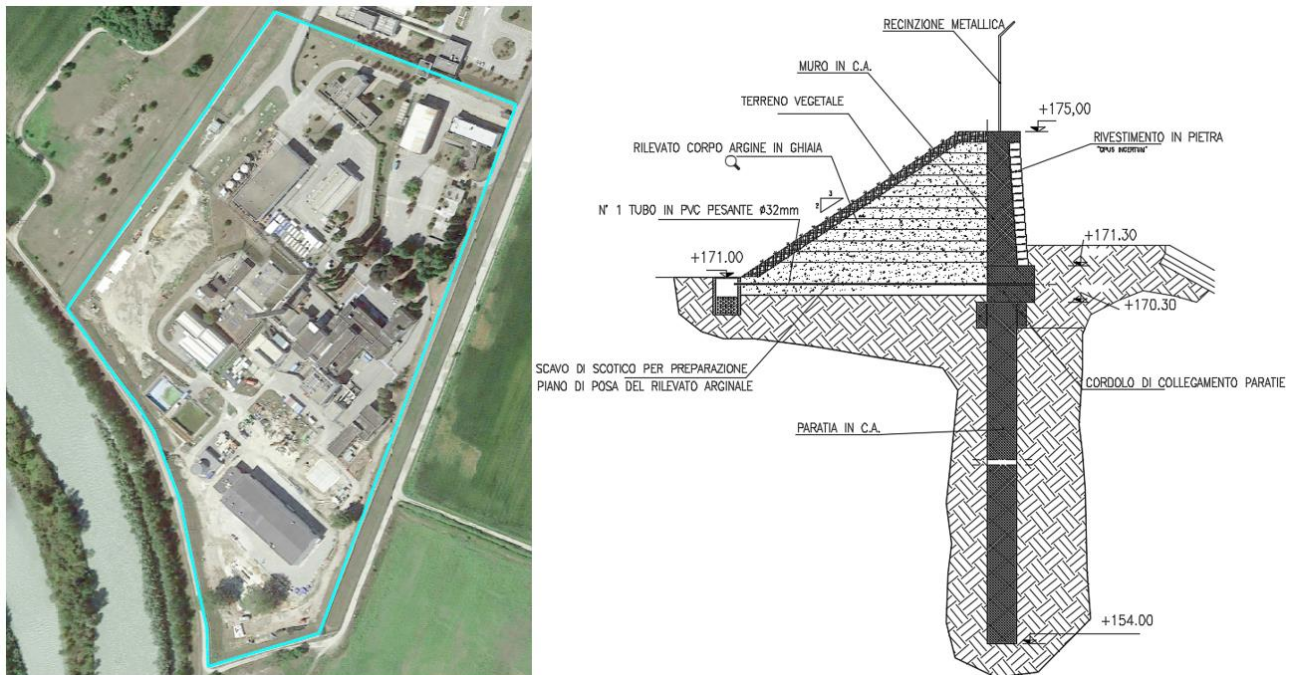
Opera di difesa idraulica perimetrale: schema planimetrico in azzurro e sezione tipo
